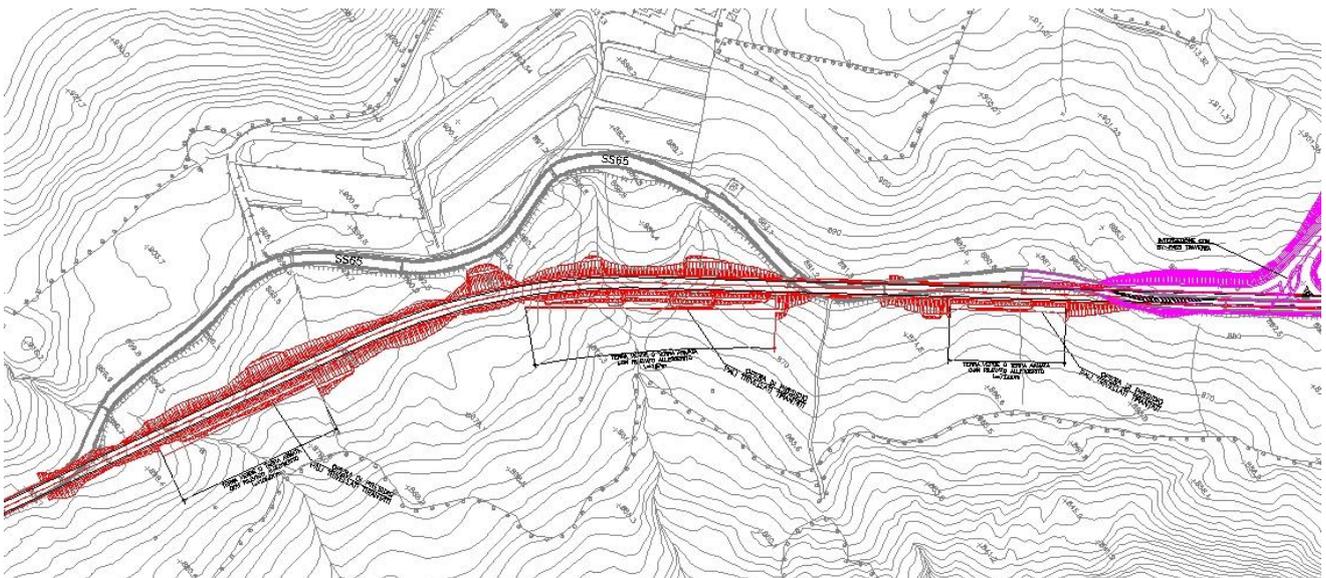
Stralcio planimetrico riqualifica SR65 della Futa nel tratto Santa Lucia
